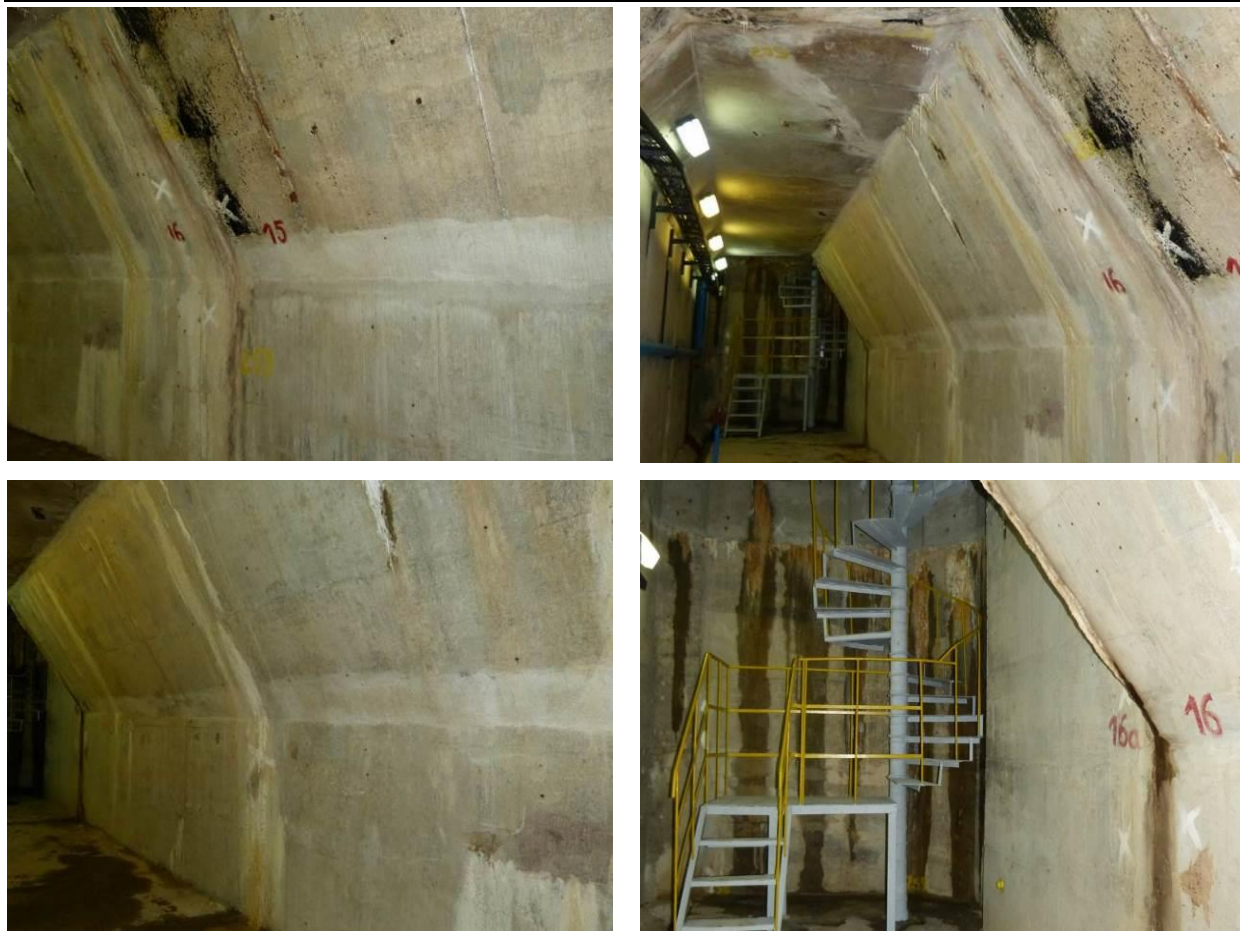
Widok na stan techniczny sekcji nr 14 konstrukcji galerii kontrolno-zastrzykowej
